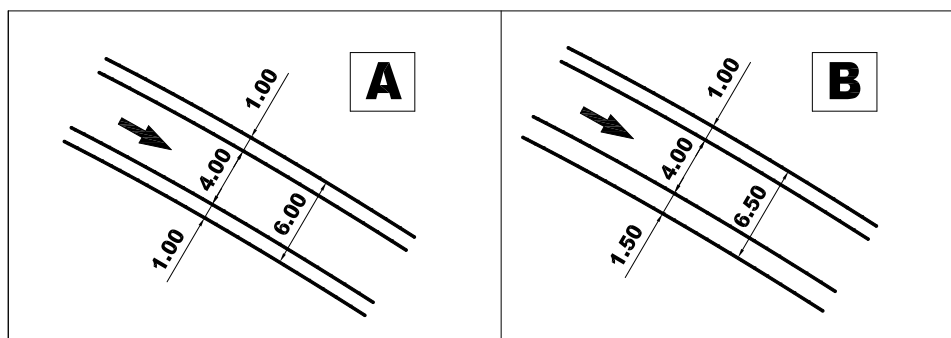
Schema planimetrico adeguamento rampa di svincolo esistente
